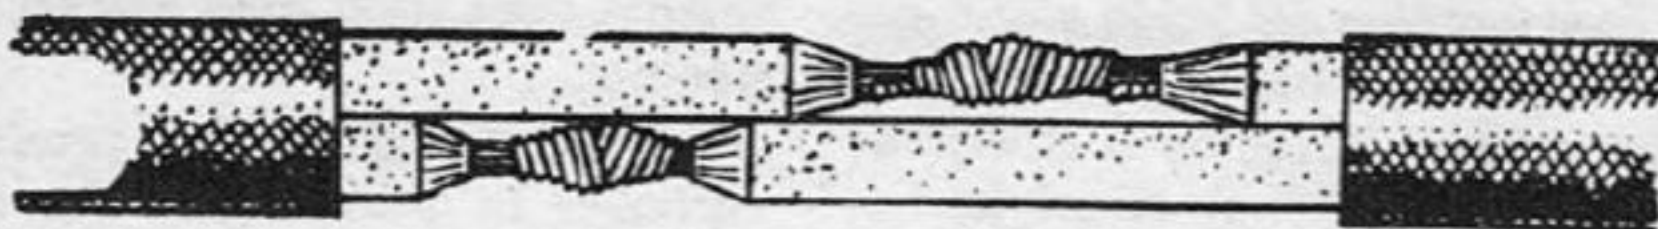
Disposición para unir dos cables dobles, alternando los puntos de unión para que quede aislante interpuesto.
